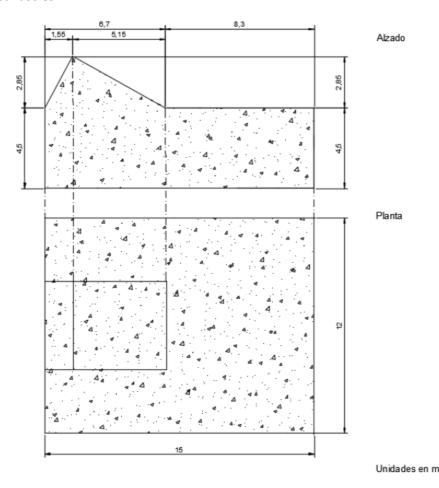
Geometría de la zapata del arco (Fuente: Propia)
